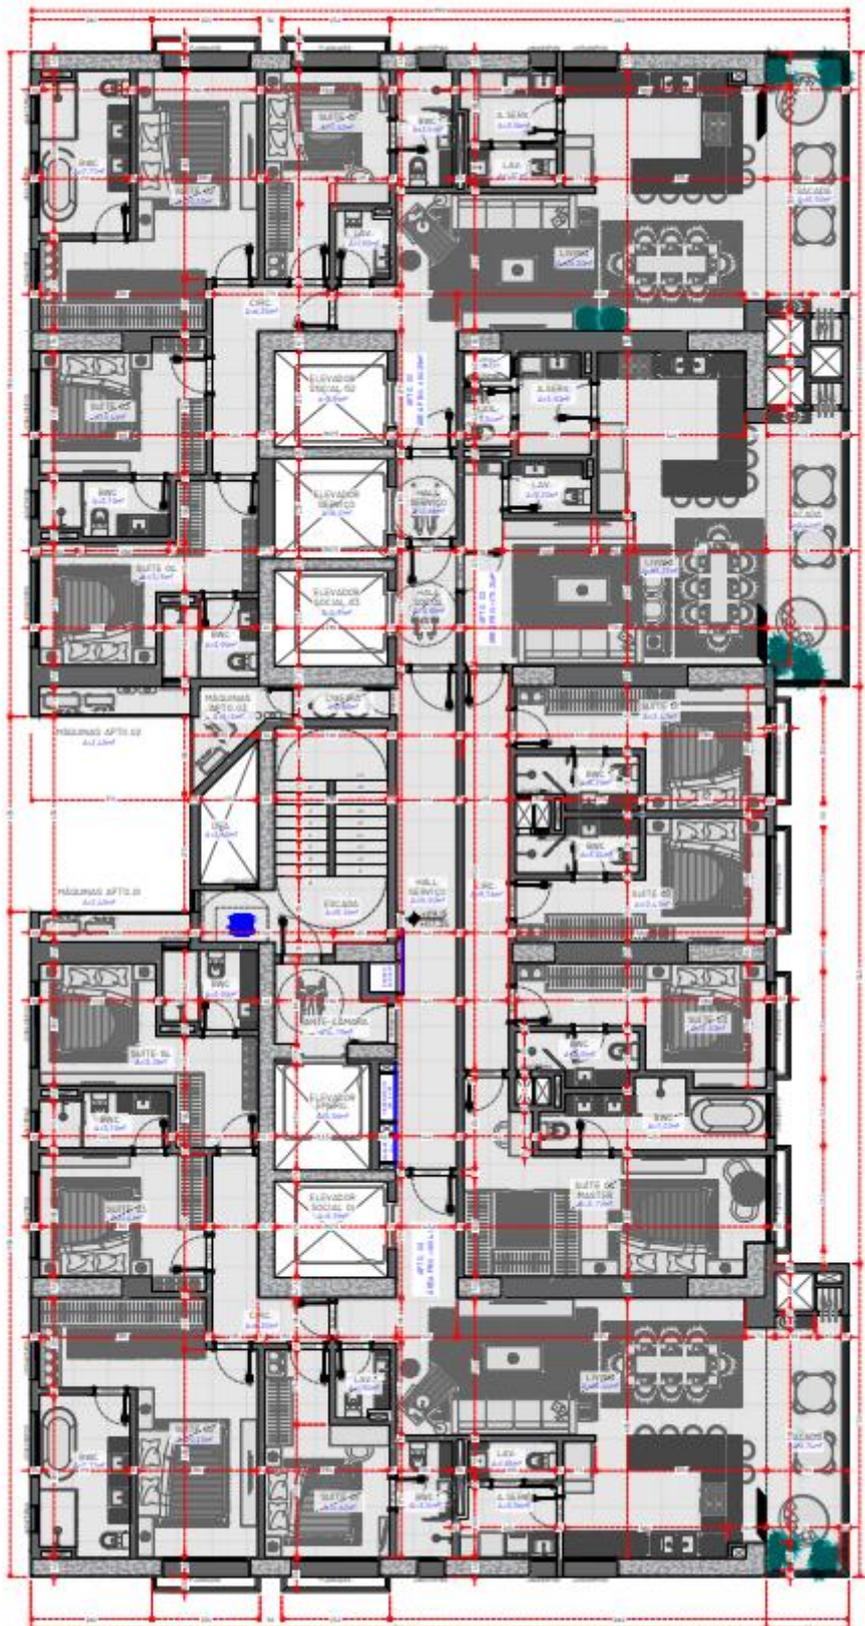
Pavimento Tipo A x 29 (10º-38º pavimento)
